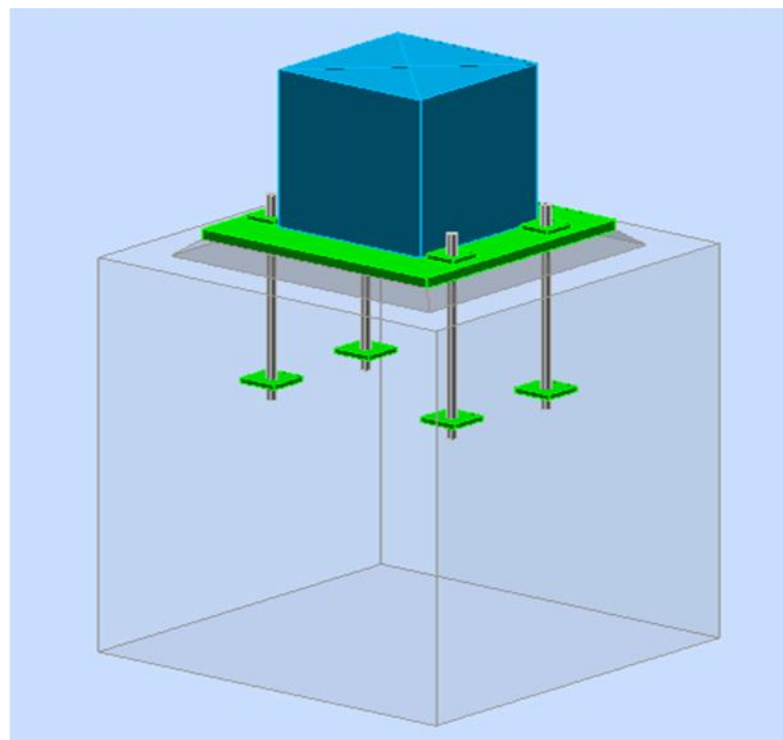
Ancrage dans la poutre pour l'effort de compression
